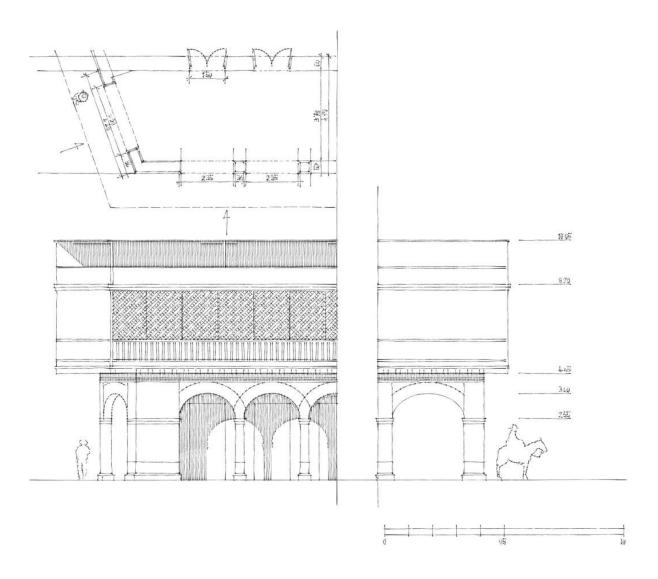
Planimetría del detalle de los Portales. Fuente: Elaboración propia.
